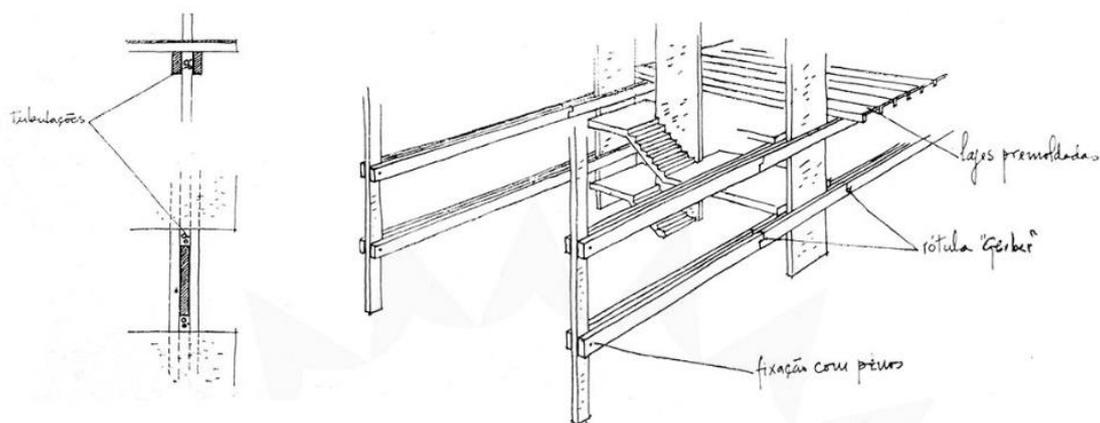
Croqui ilustrativo da seção da estrutura e seus elementos estruturais feito por Lelé.
